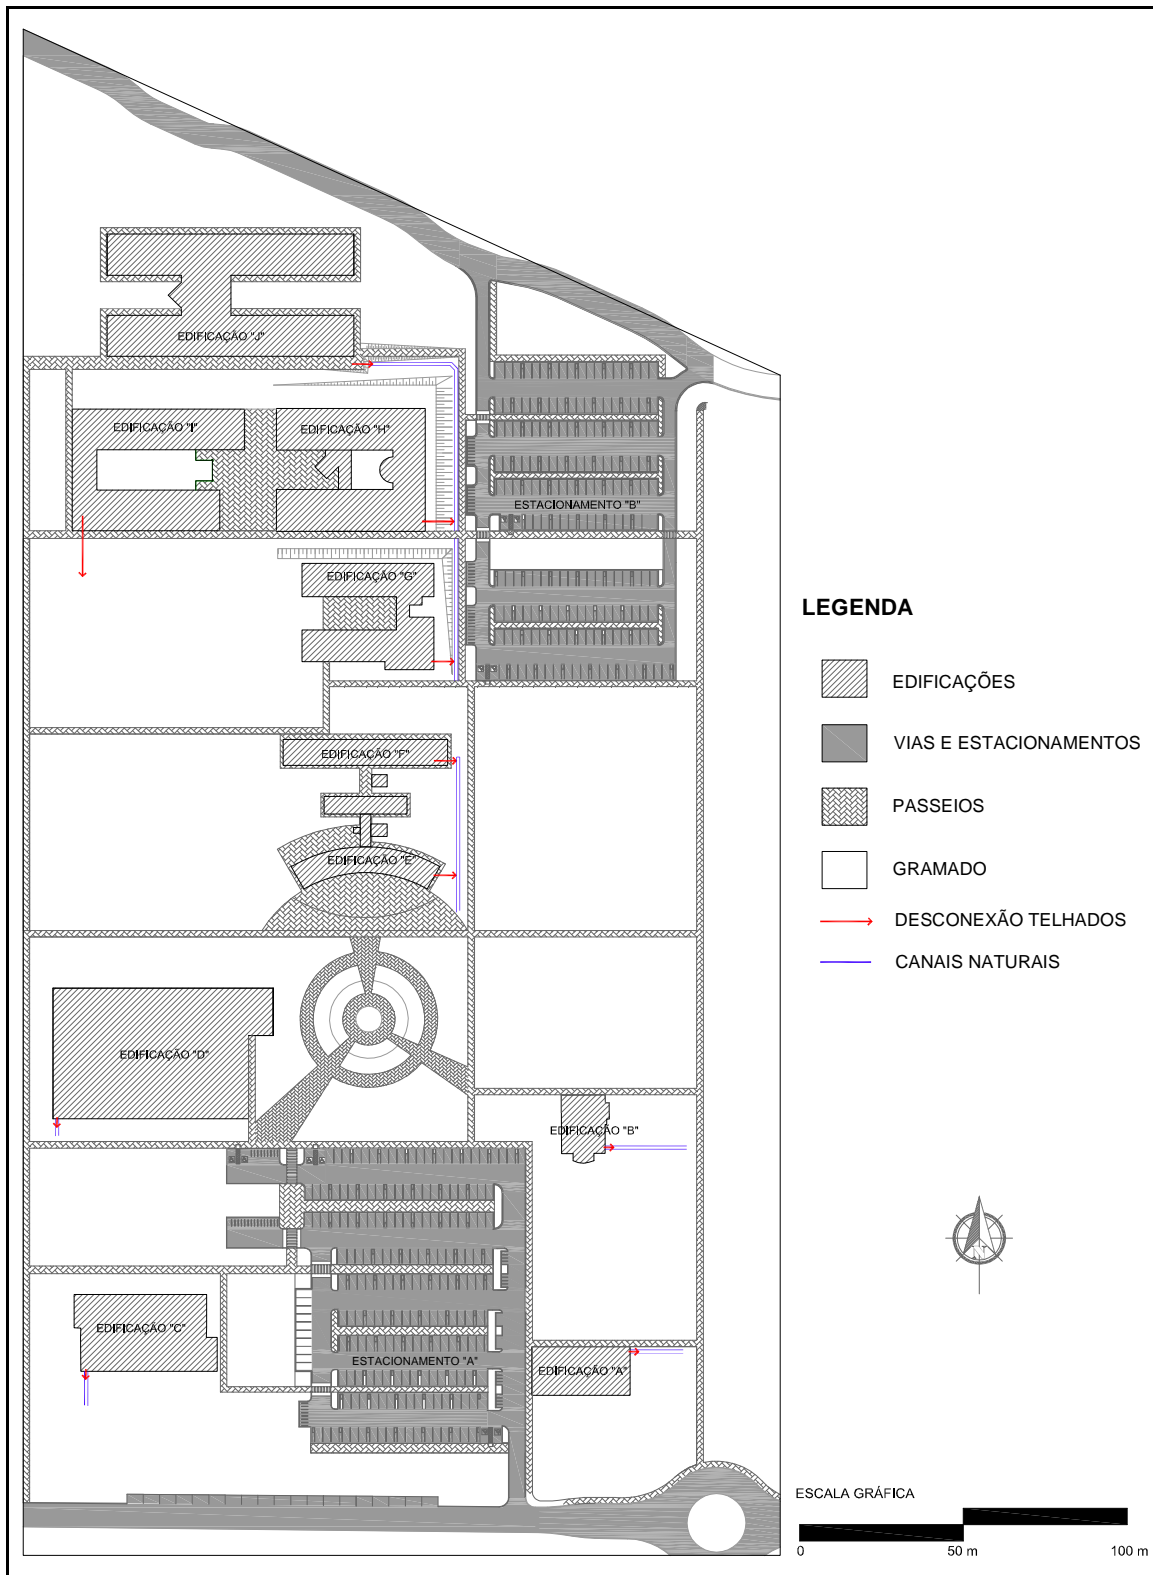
Implantação com localização de canais naturais de drenagem.
